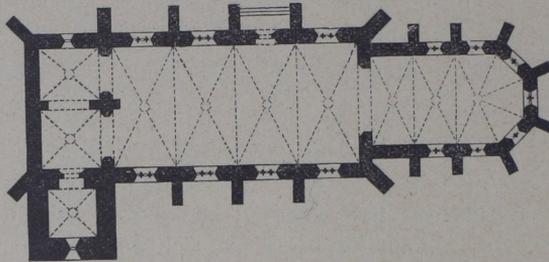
Grundriss der Apollinarskirche in Prag.
